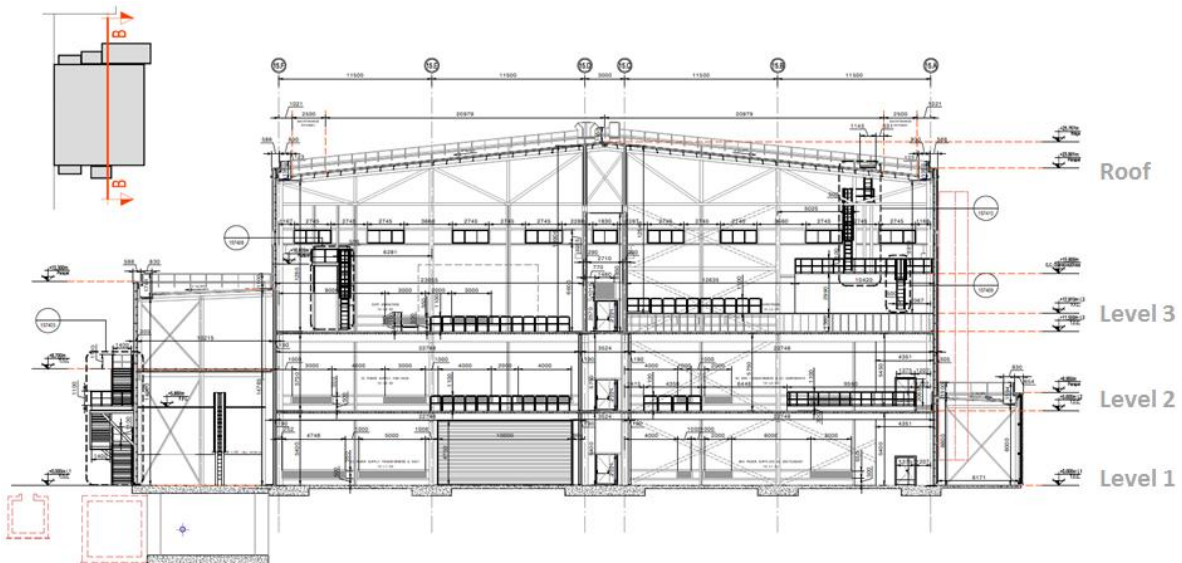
Construcción del RF Heating Building#15 (Noviembre de 2016).
